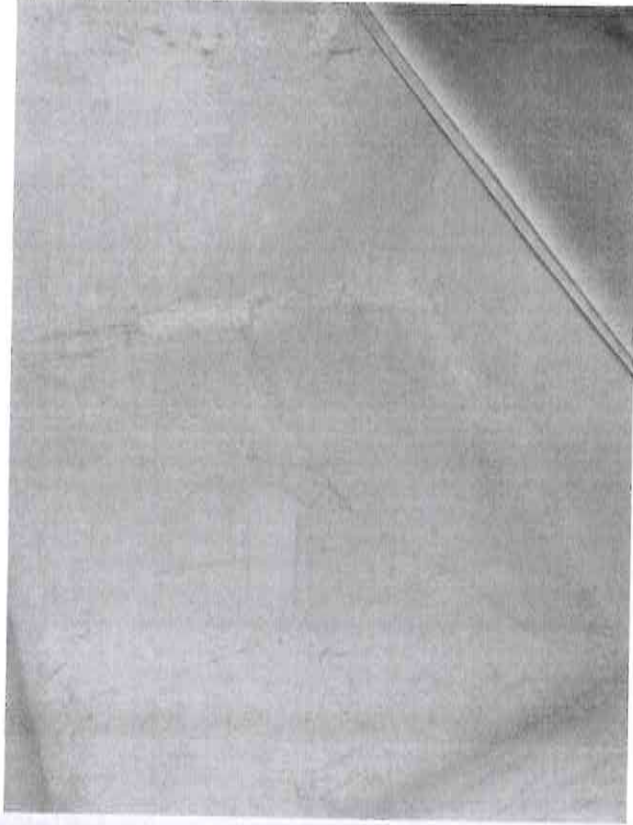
Nivel 4, se aprecian fisuras en la capa de compresión, de la losa nervada.
